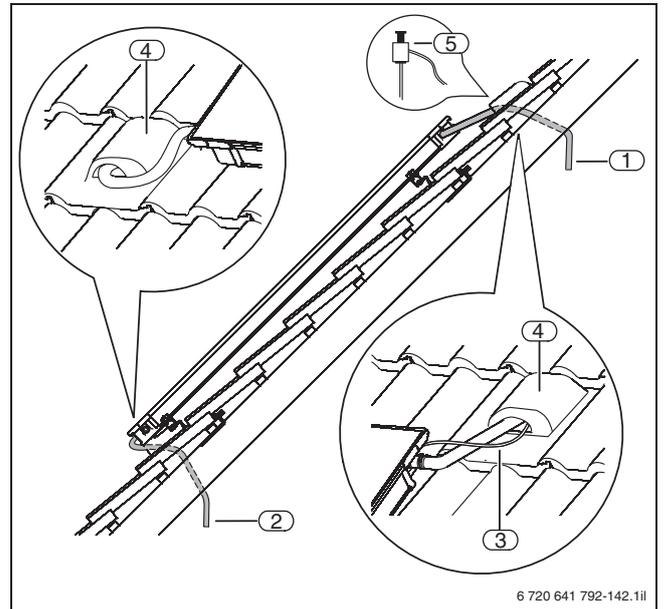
Sistemazione delle condutture di allacciamento sotto il tetto
